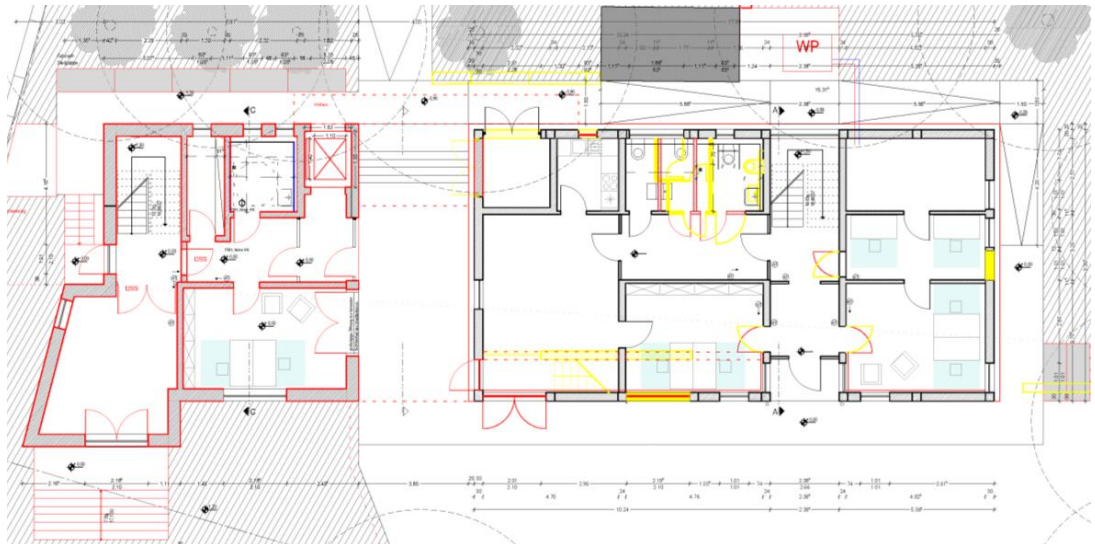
Grundriss Erdgeschoss, Quelle: Rittmannsperger Architekten
